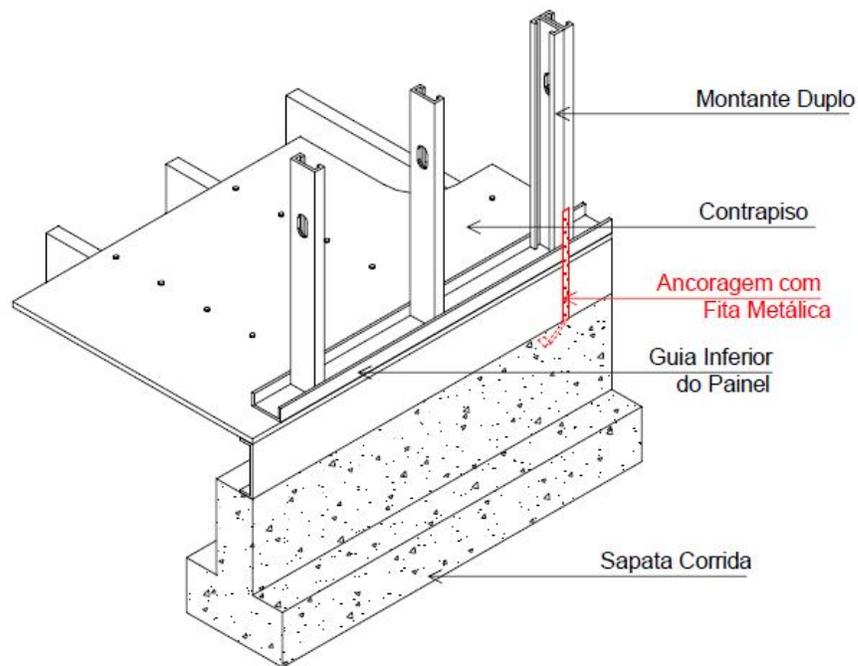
Fitas metálicas para ancoragem e estabilização de painéis (Adaptado de FREITAS; CRASTO, 2006)
